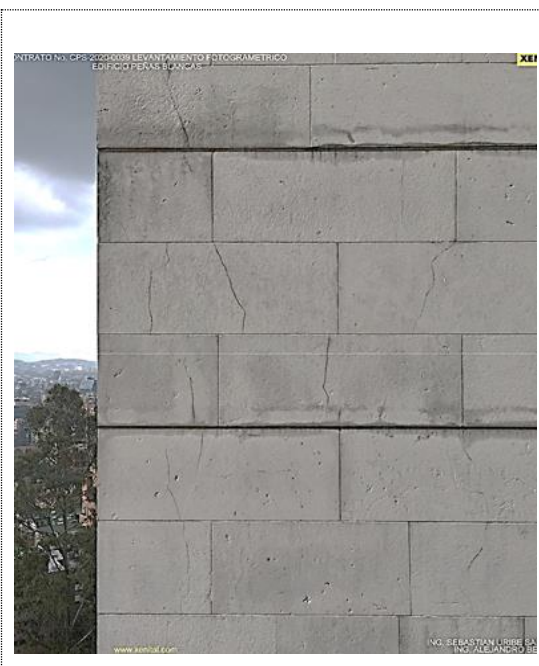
Imagen original de deterioro, piedra fisurada.
